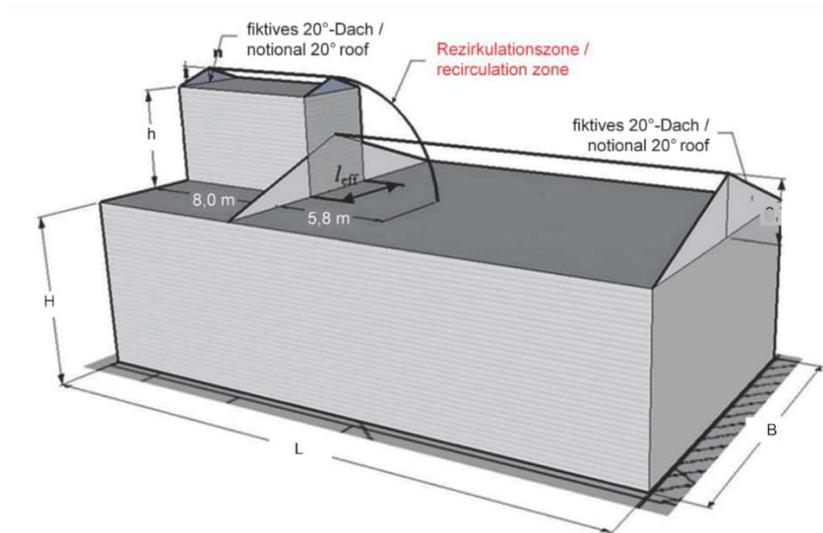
Prinzipskizze zur Ermittlung der Schornsteinhöhe an einem Einzelgebäude mit Dachaufbau. Aus: VDI 3781, Blatt 4.
